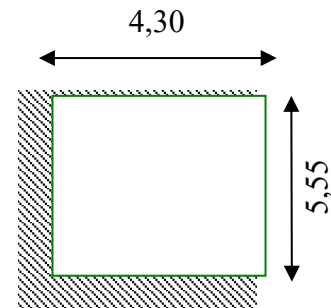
Dimensions du panneau de dalle le plus sollicité
